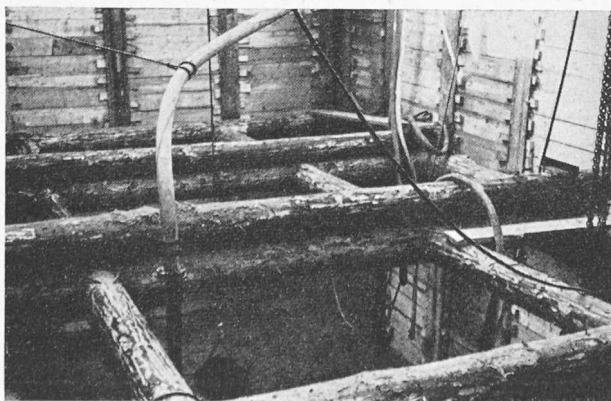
Die Verspriessung im unteren Schachtteil vor dem Einbau der Betonsohle
